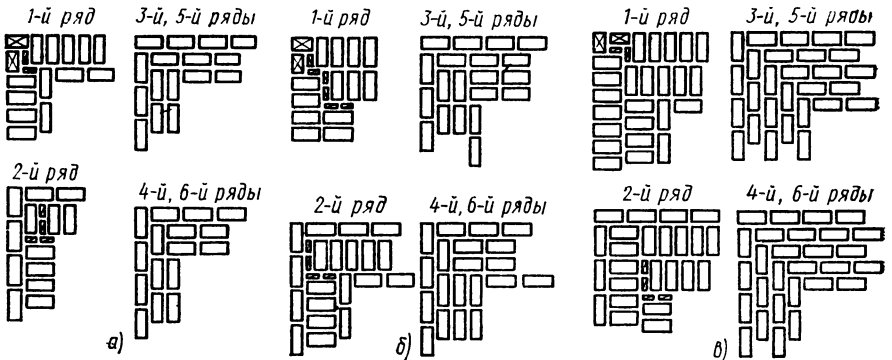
Порядовая раскладка кирпича по многорядной системе перевязки швов при кладке углов толщиной:
